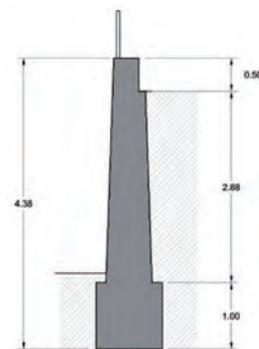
SECCIÓN DEL MURO DERRIBADO EN 1907
